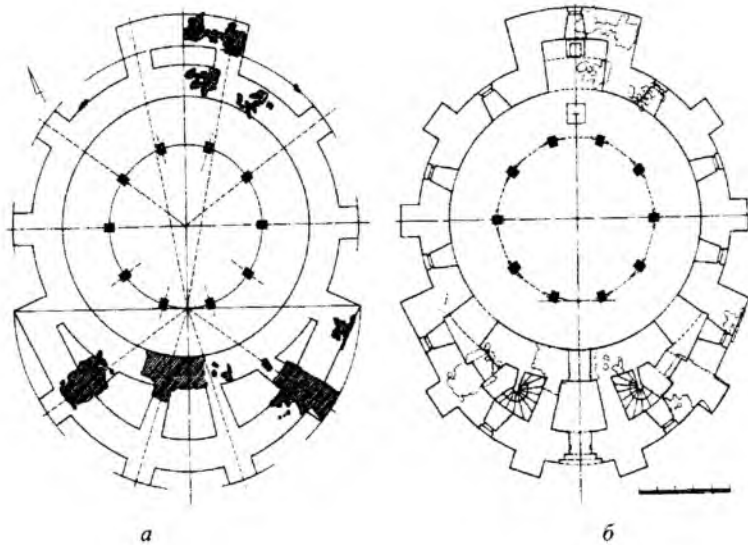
Особливості планувальної композиції Київської ротонди, виявленої в межах найдавнішого городища на Старокиївській горі: а – реконструкція плану фундаментів; б – реконструкція плану споруди: А, Б, В, Г, Д, Е, Є, Ж – фрагменти фундаментів та розписи каміння
